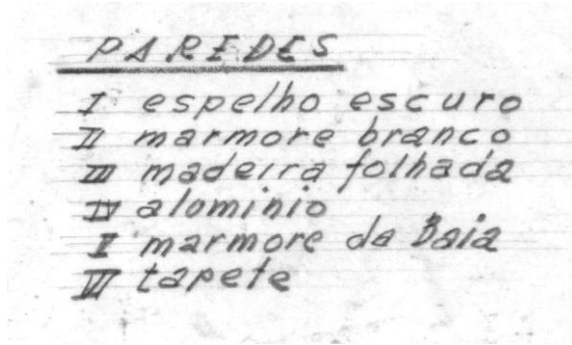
Detalhe da legenda - Planta Baixa, 4º Pavimento (1960). Carimbo: NOVACAP, TOSC 10.4. Conteúdo: Planta cota +21,00. Desenhista: R. Frontini. Data: 10/03/60. Fonte: ARPDF.
